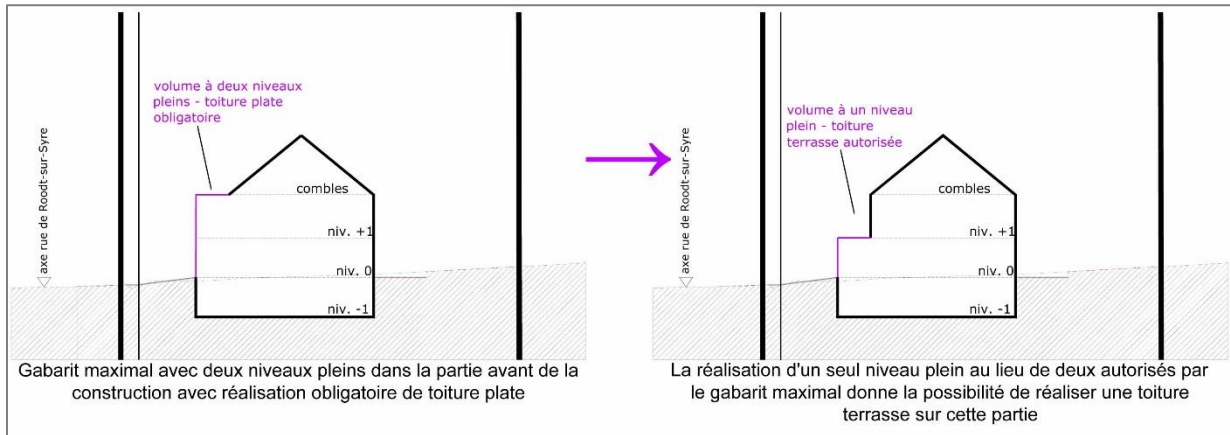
Modèle de réalisation d'une toiture terrasse sur le volume avant de la construction destinée au séjour prolongé
